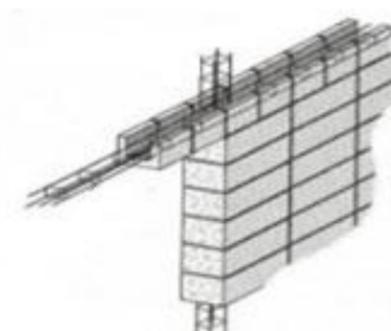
Detalle de Pared de Mampostería Reforzada
